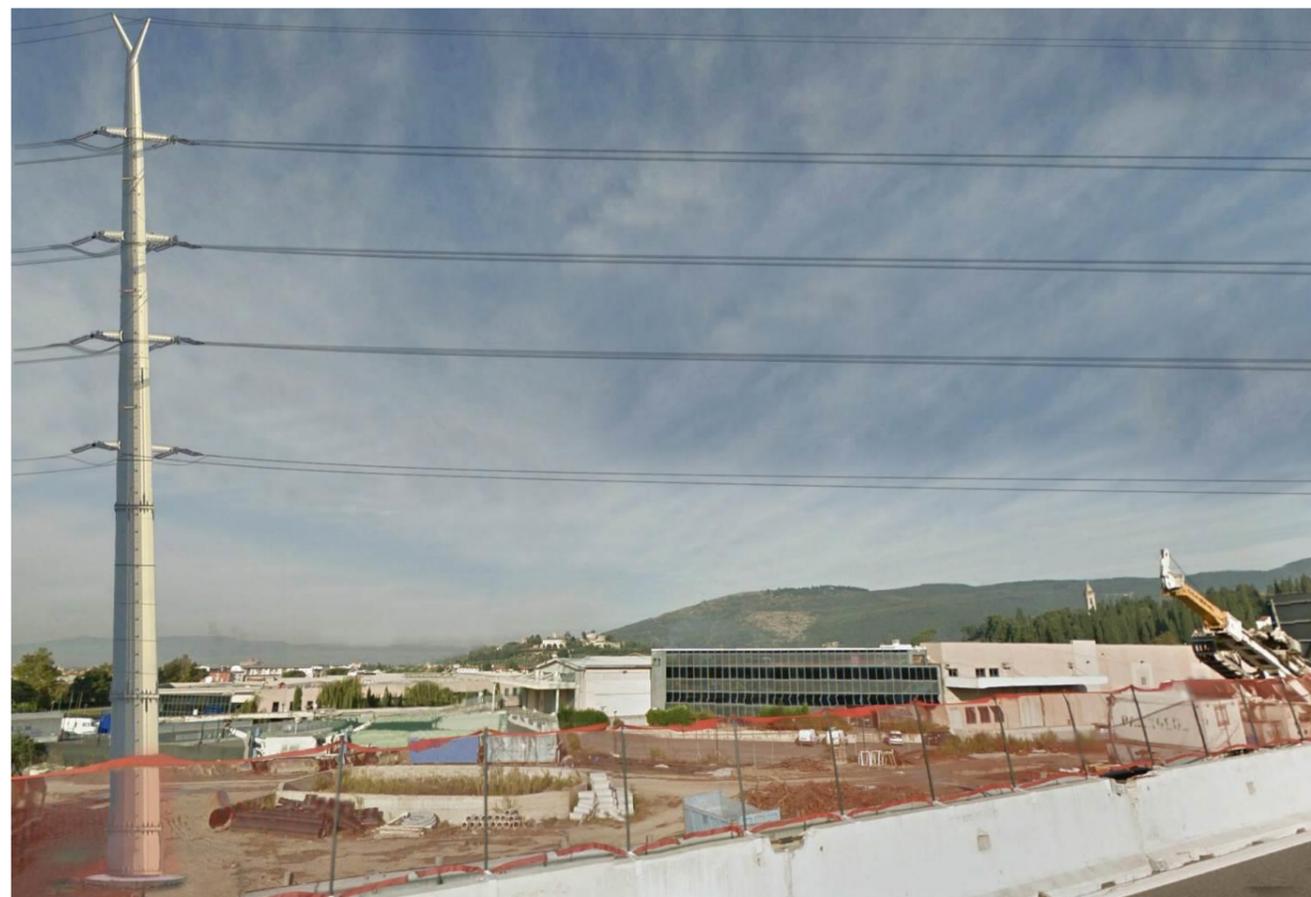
Vista dall'autostrada del Sole – PROGETTO CON SISTEMA A LOOP PASSIVO oggetto di analisi
